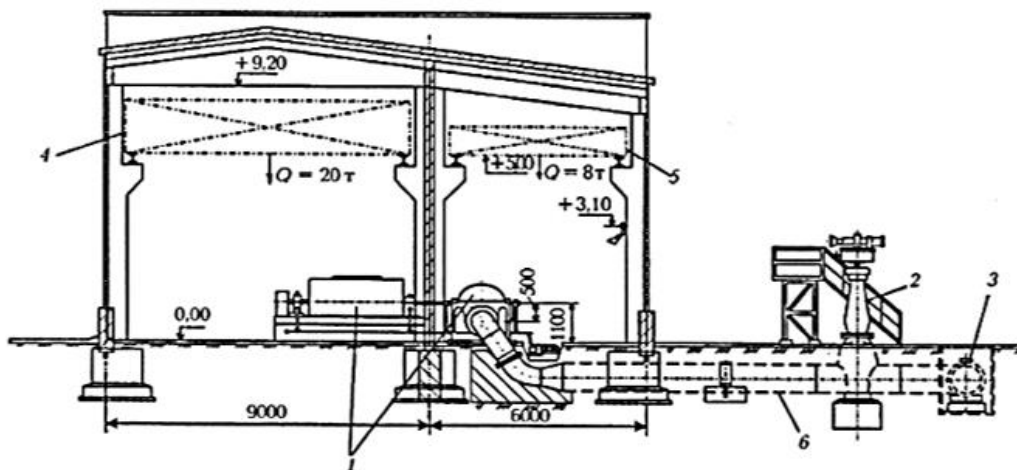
Насосный цех, оборудованный насосными агрегатами
